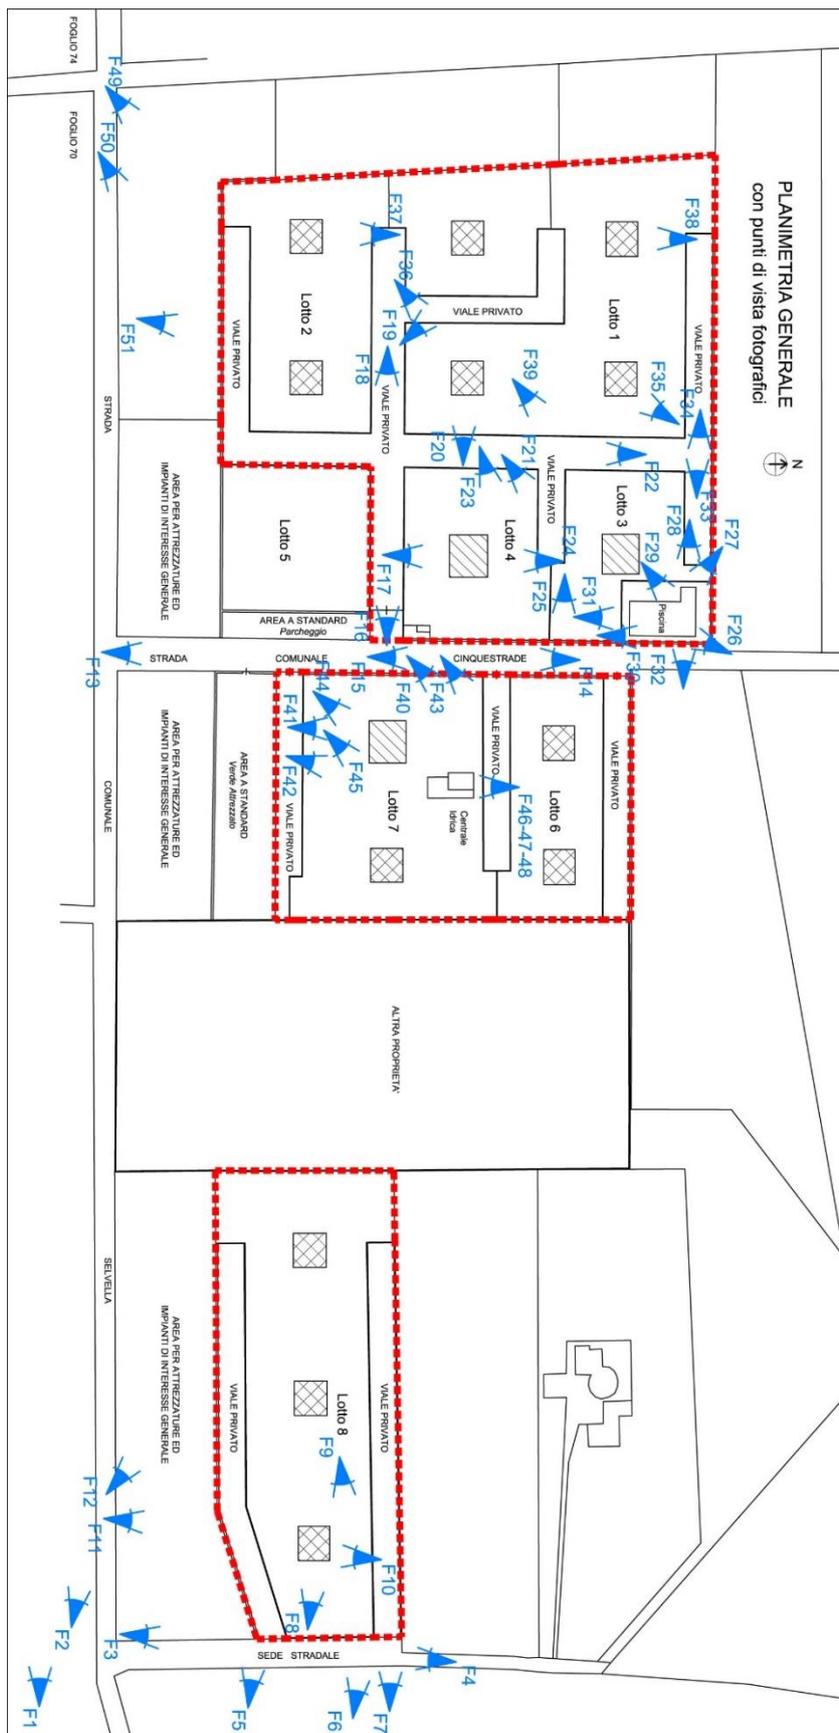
planimetria complesso residenziale "Mercadante" con punti di vista fotografici
